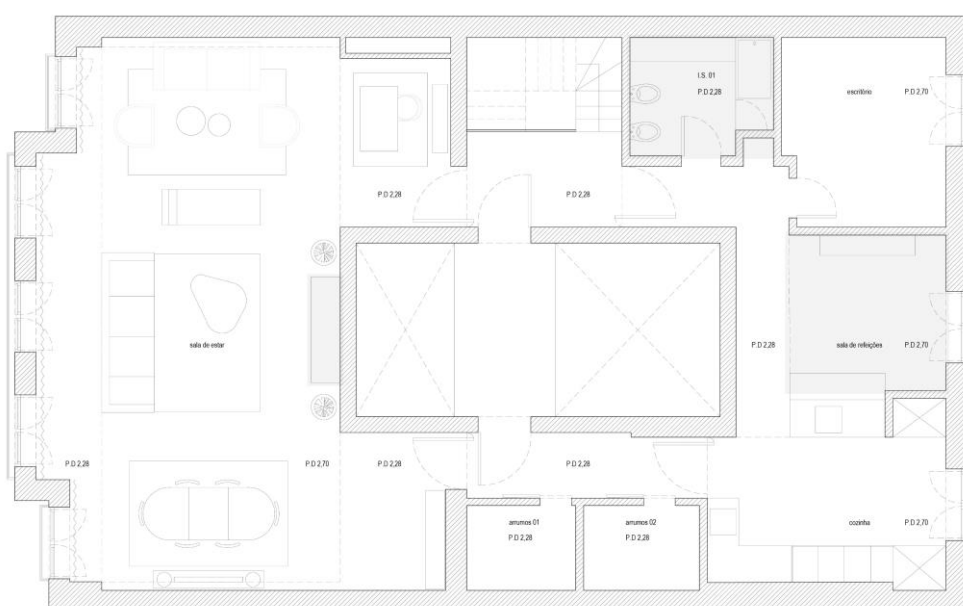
Planta do Piso 1. Projecto 5. Fonte: Arkstudio.
